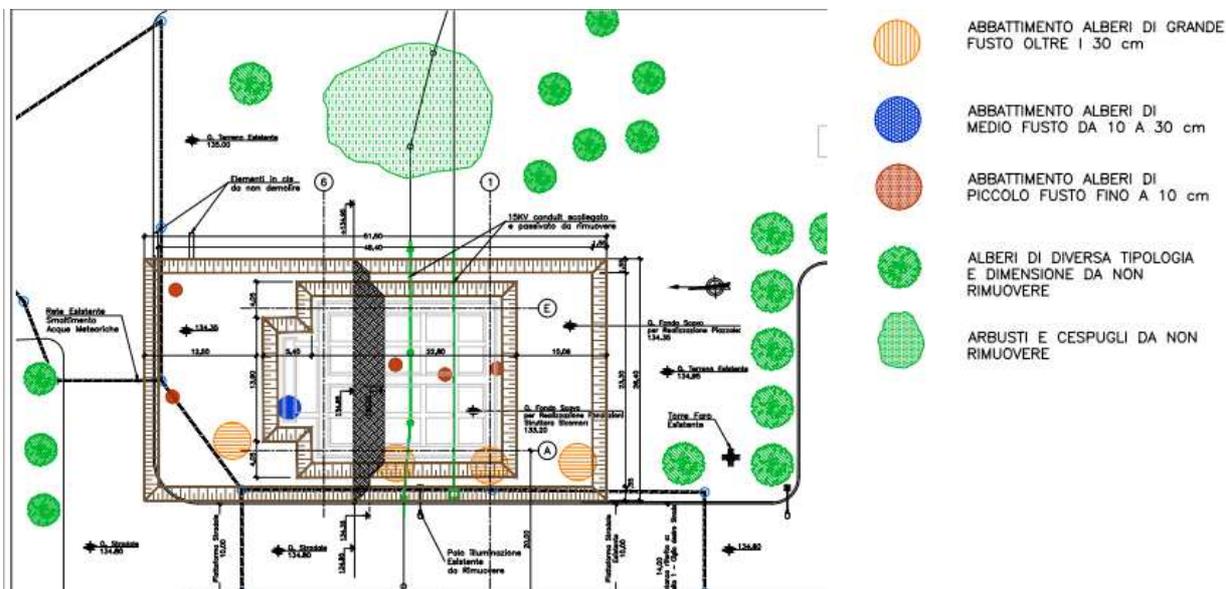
Planimetria rimozione e scavi – Impianto Sicomor
